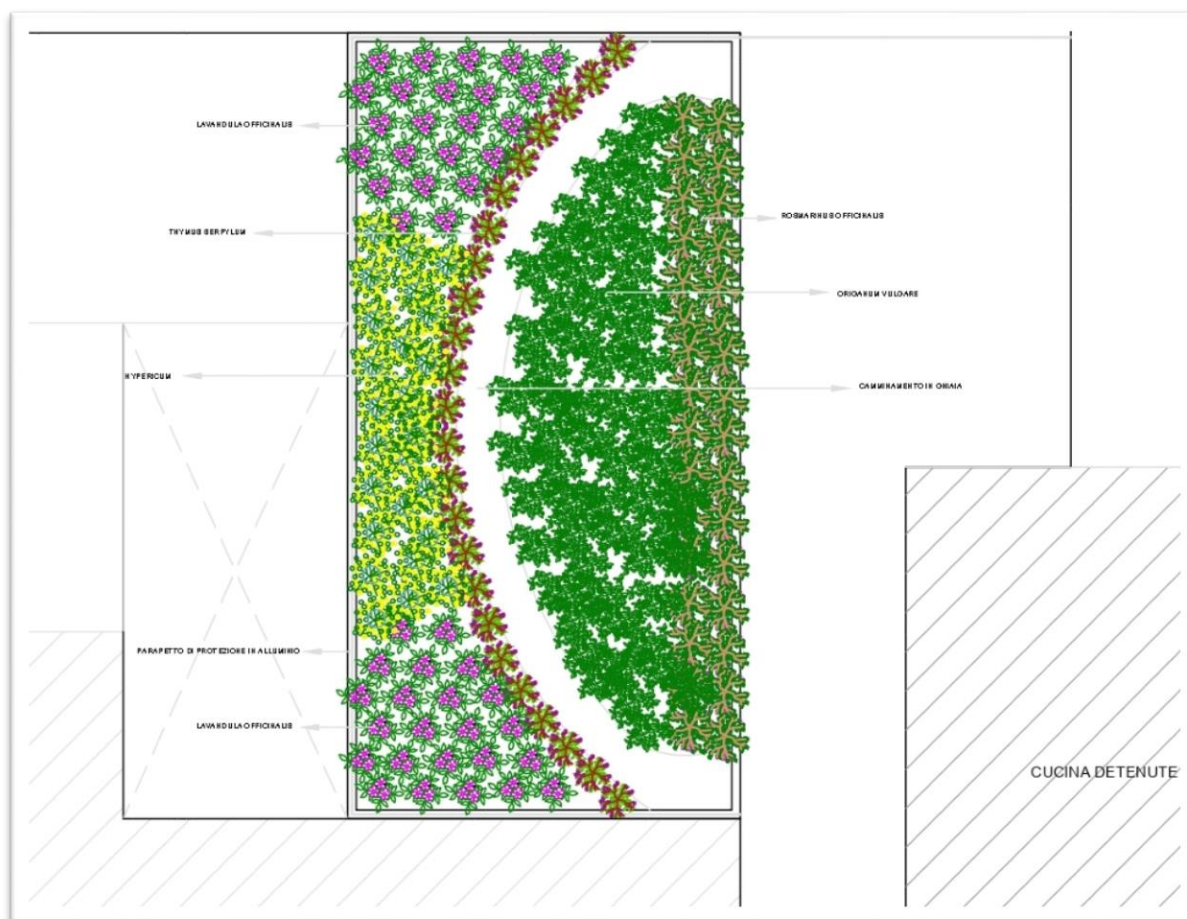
Schema della distribuzione planimetrica
